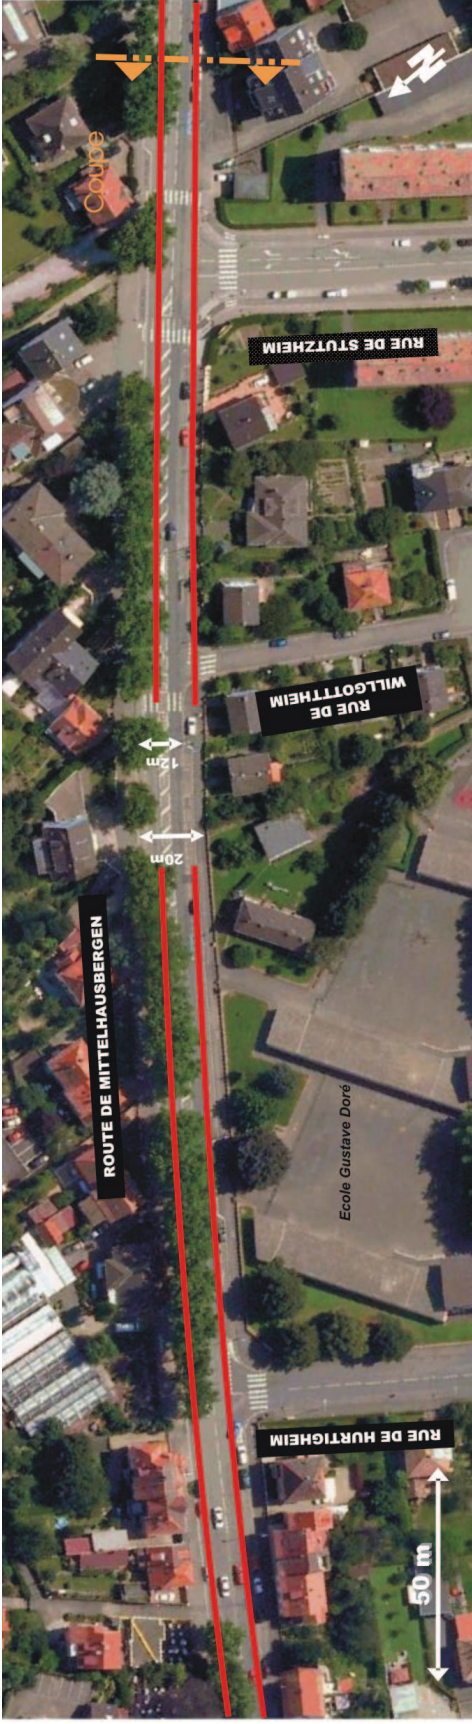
Point dur d'insertion de la variante 5 (Route de Mittelhausbergen/Ouest)
